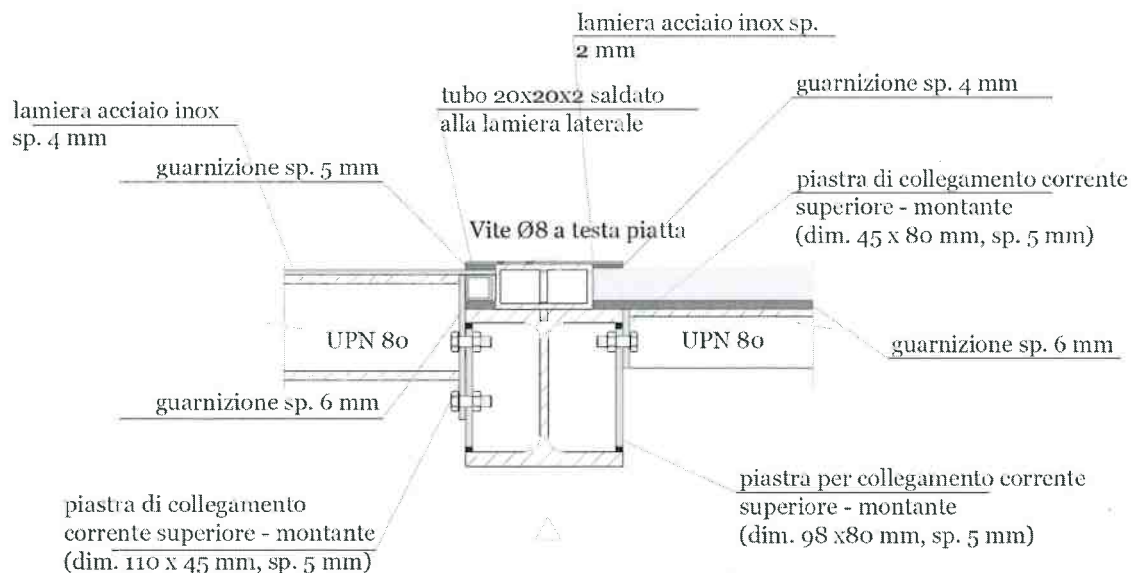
Particolare sezione in pianta sistema di tenuta a "wafer" per parete laterale tipo 1
